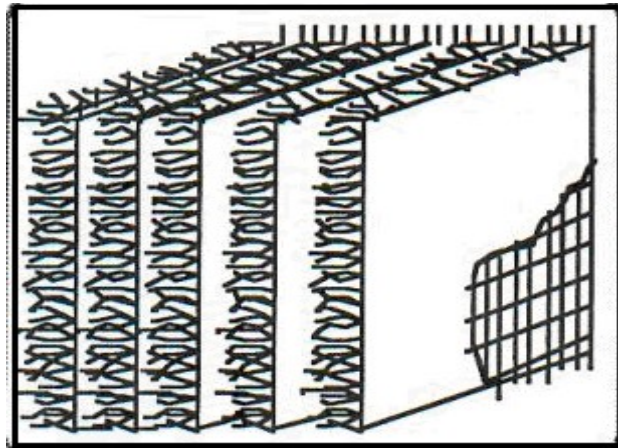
Assemblage de la fourrure en panneaux de grilles [2].
